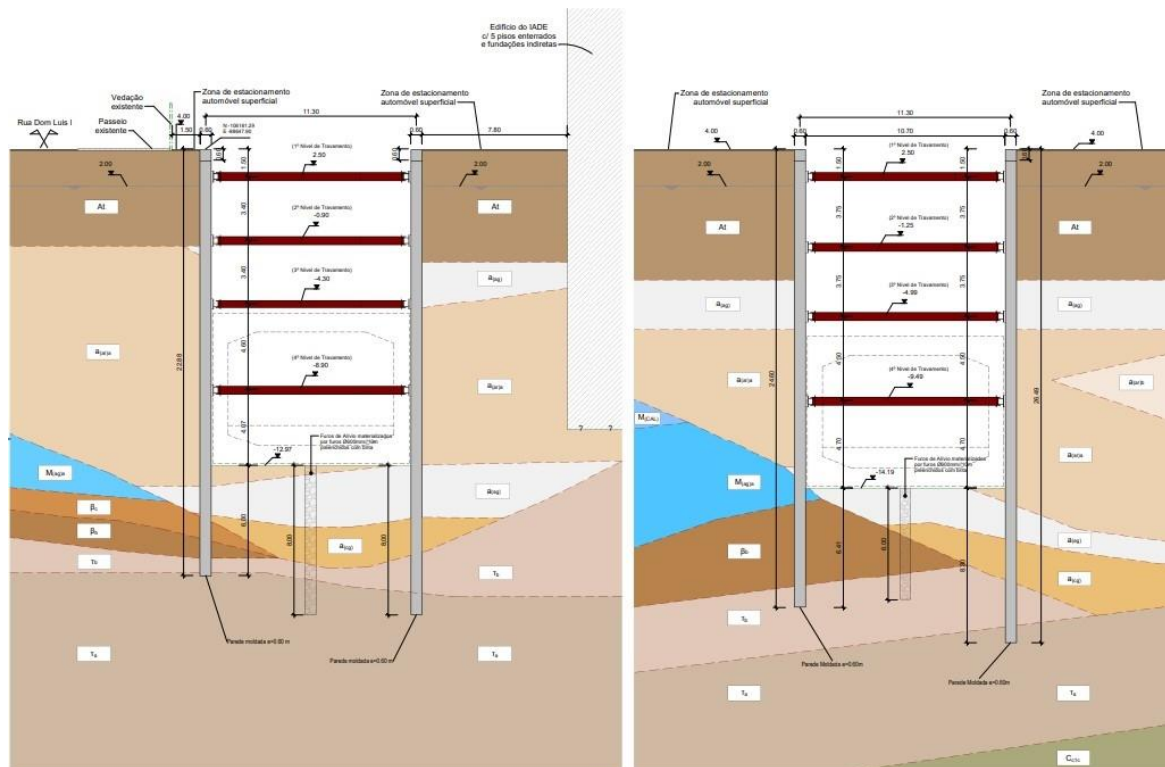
Corte Transversal CT PK 1+643 (à esquerda) e Corte Transversal PK 1 +675 (à direita) (Lisboa, Projeto de execução - RACS MSS PE GEO TUN T35 DW)
